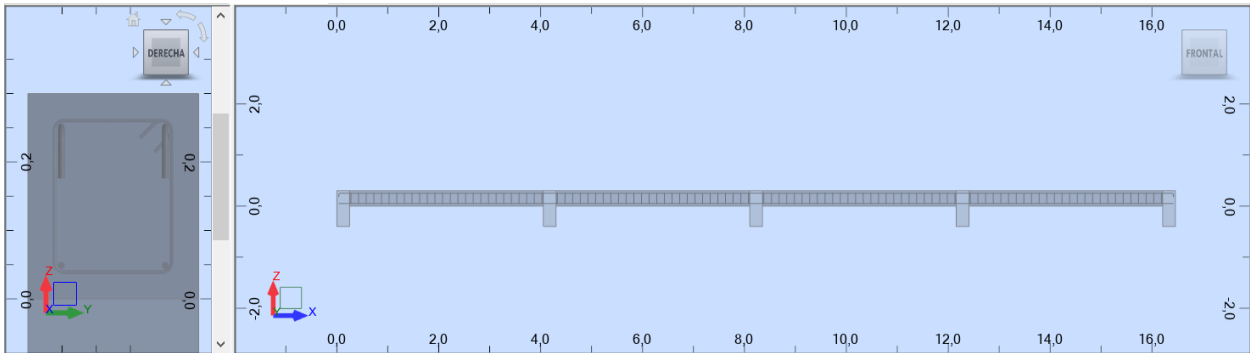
Vista 3D de la armadura realizada para un pórtico en concreto
